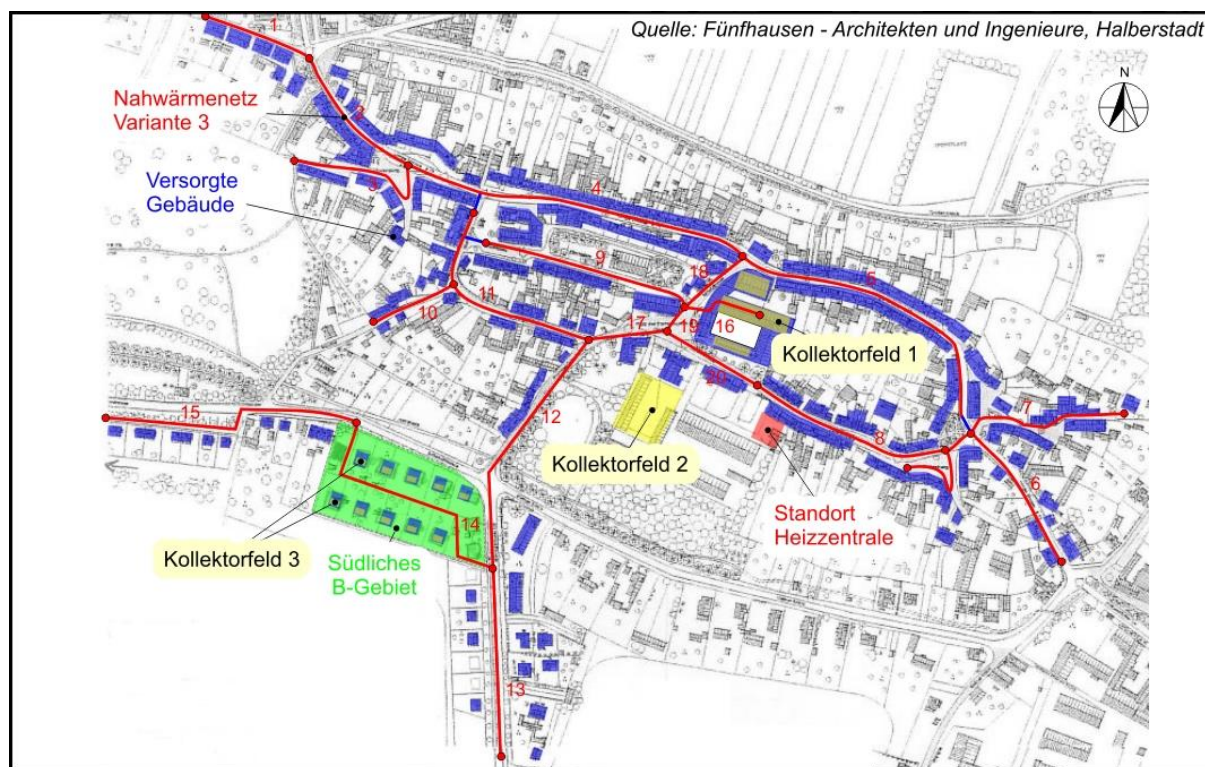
Lageplan Regenerativstadt Dardesheim – Landkreis Halberstadt
